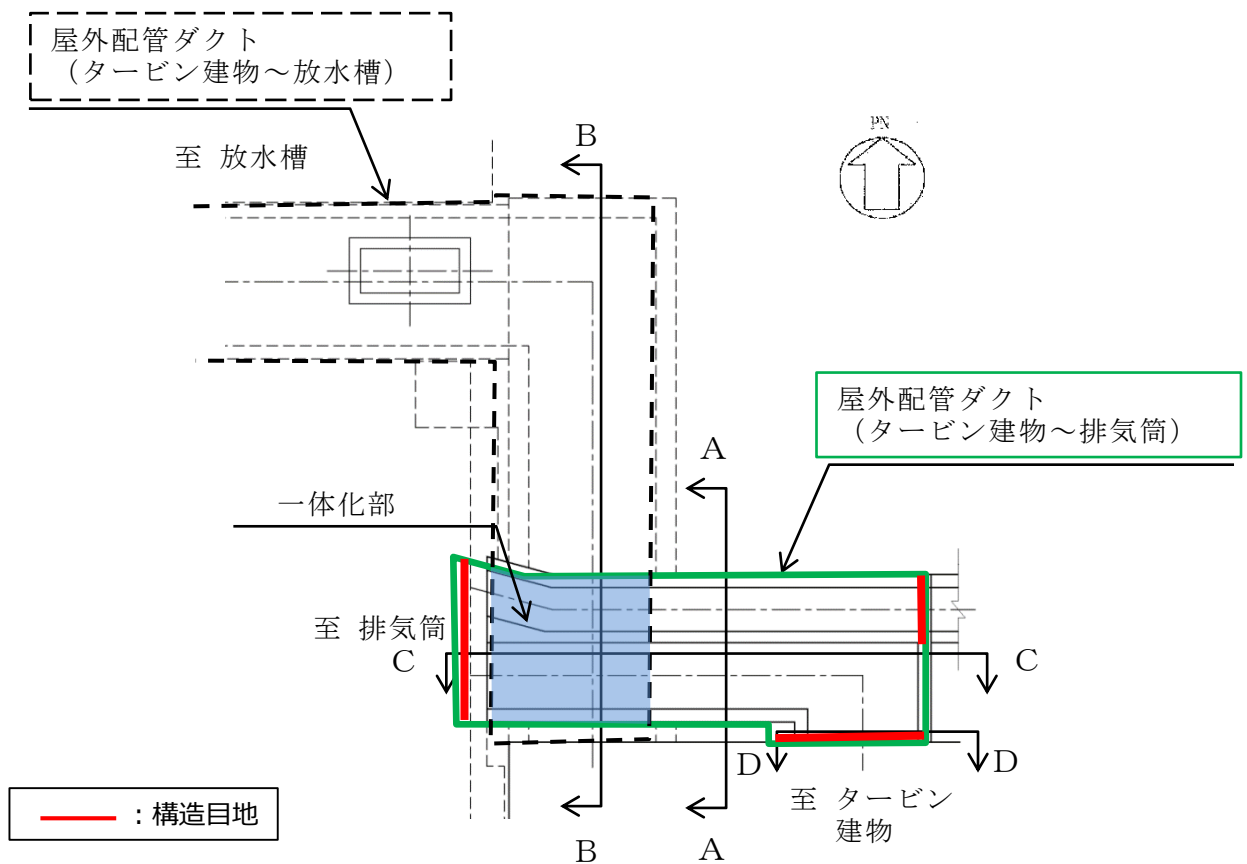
屋外配管ダクト（タービン建物～排気筒） 平面図
